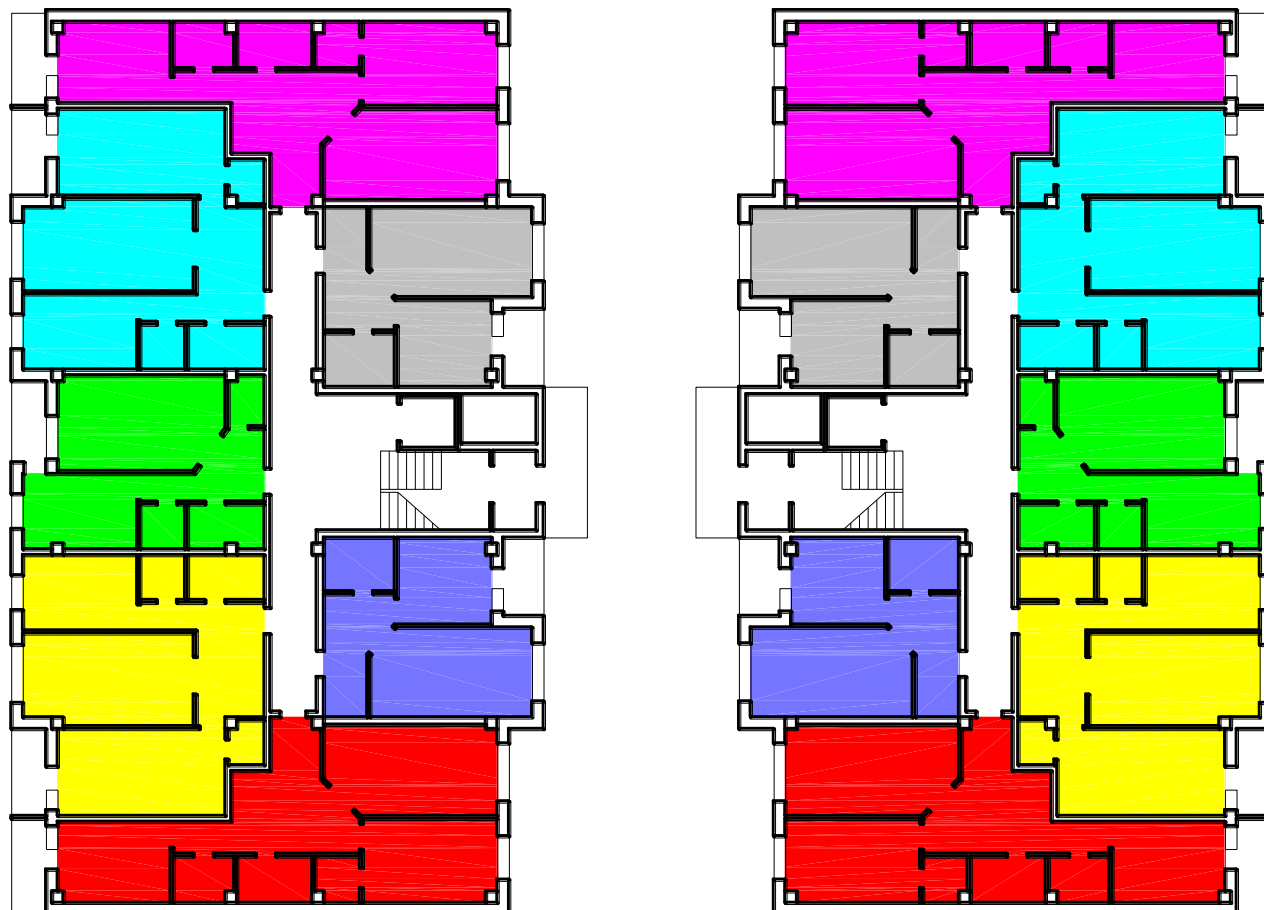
Планувальне рішення секції житлових будинків з різною орієнтацією фасадів.
